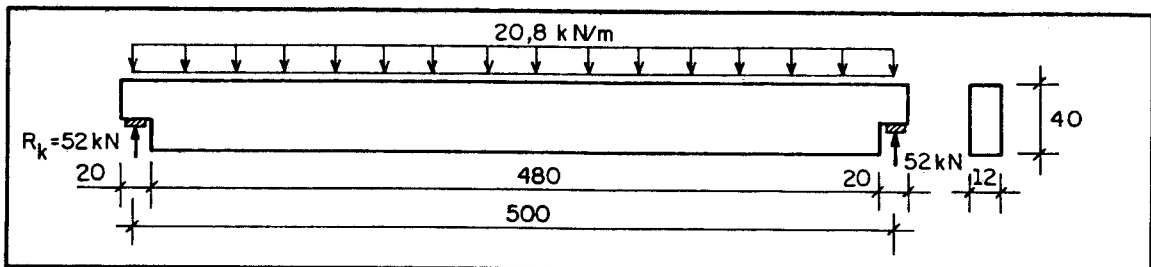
Viga com apoio em dente do exemplo 8
